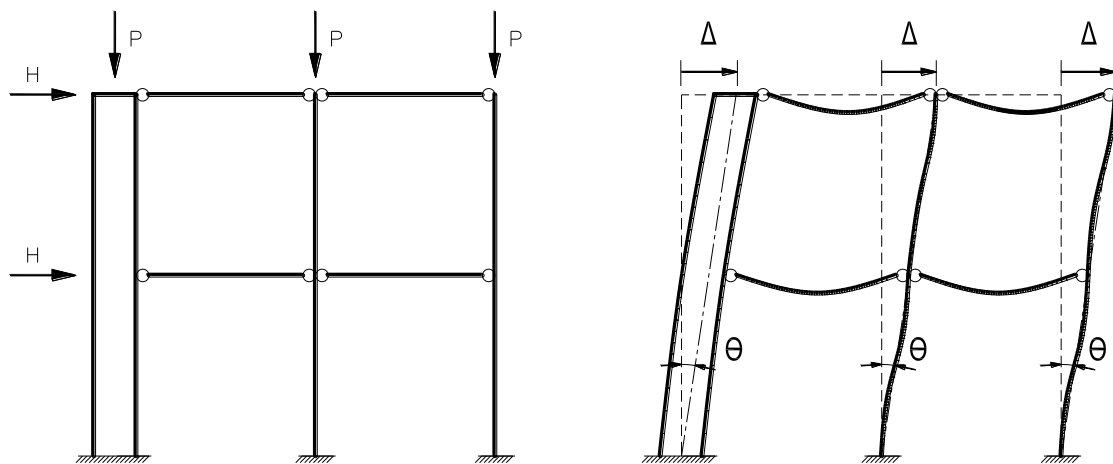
Esquema sobre o efeito de contraventamento numa estrutura
